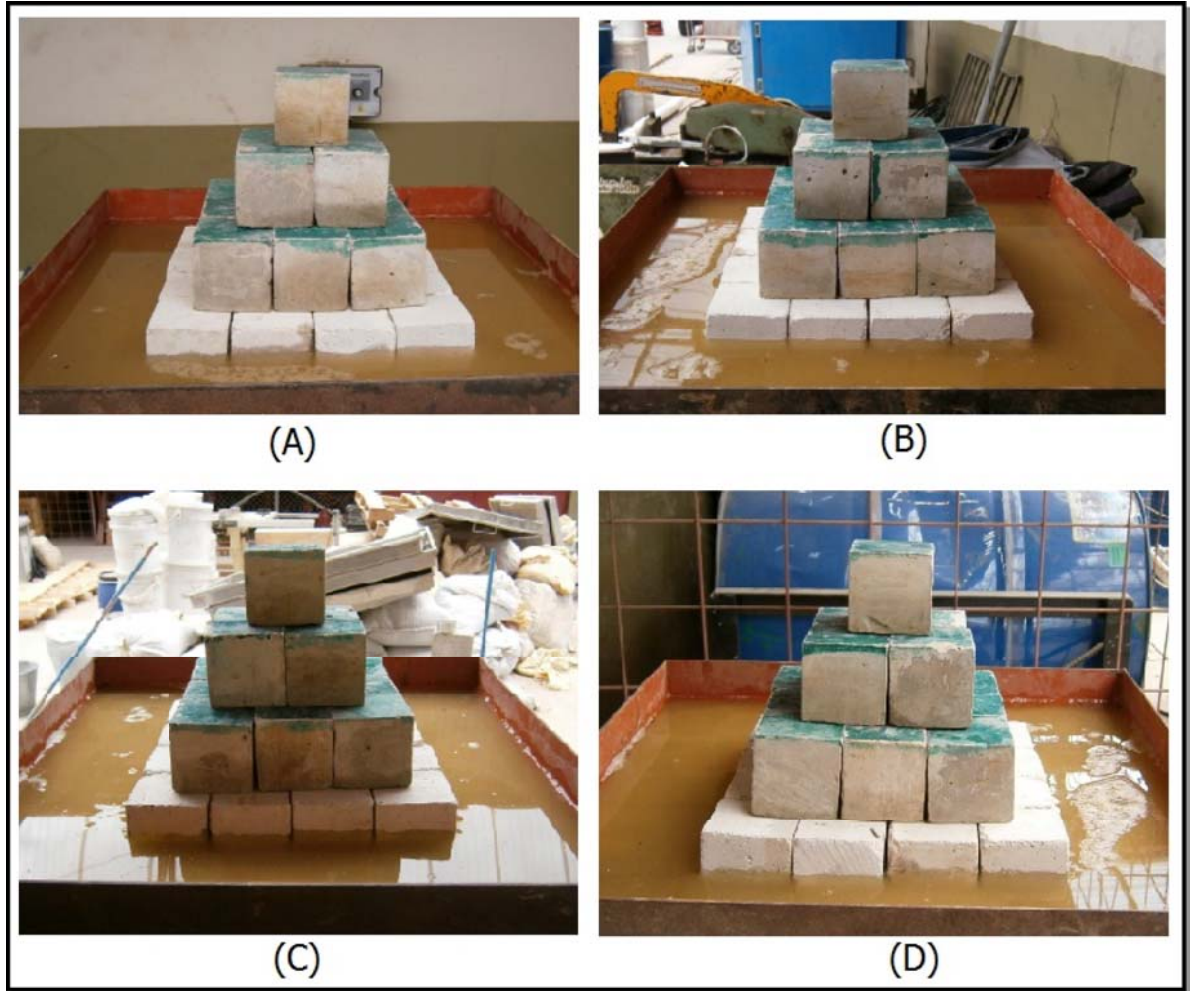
Resultado del modelo a escala con arena de río 100%. (A) Fachada norte, (B) fachada este, (C) fachada sur, (D) fachada oeste
